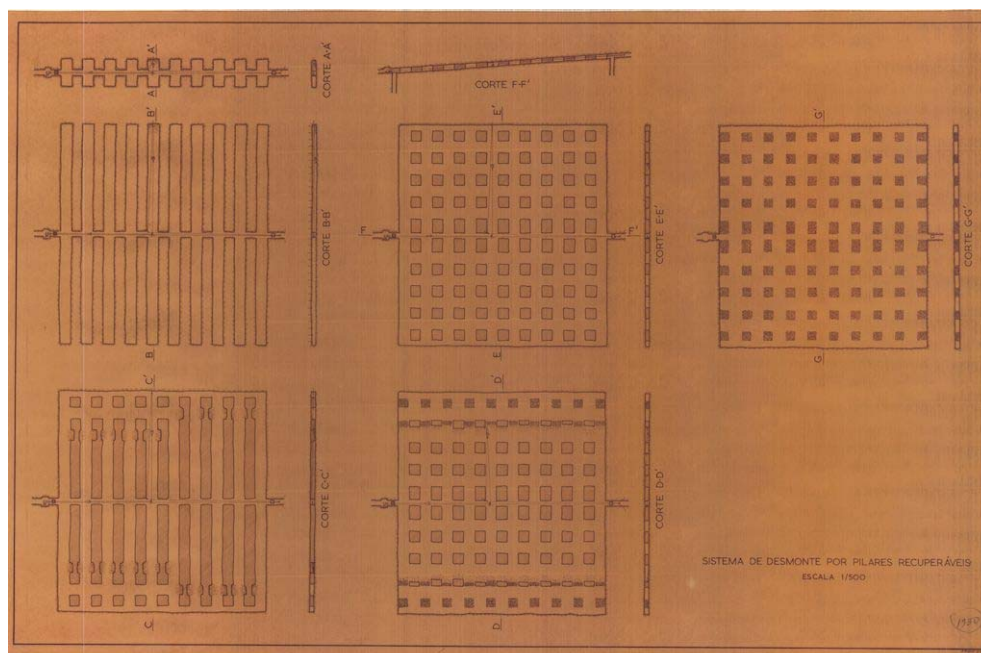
Desmonte de câmaras e pilares com recuperação de pilares
